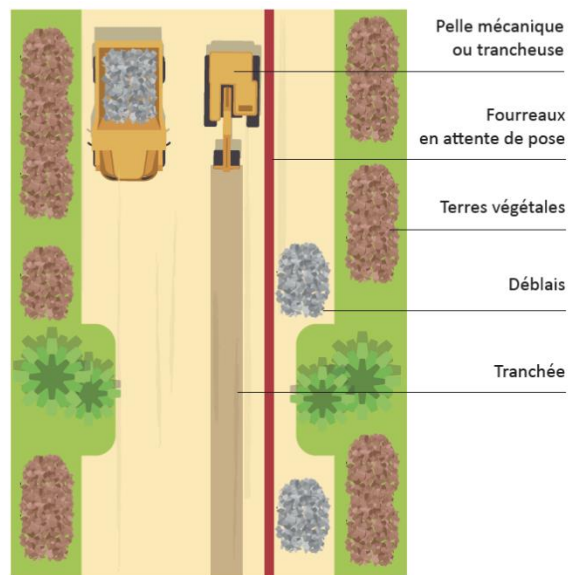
Emprise chantier au droit d'une tranchée - Vue en plan
